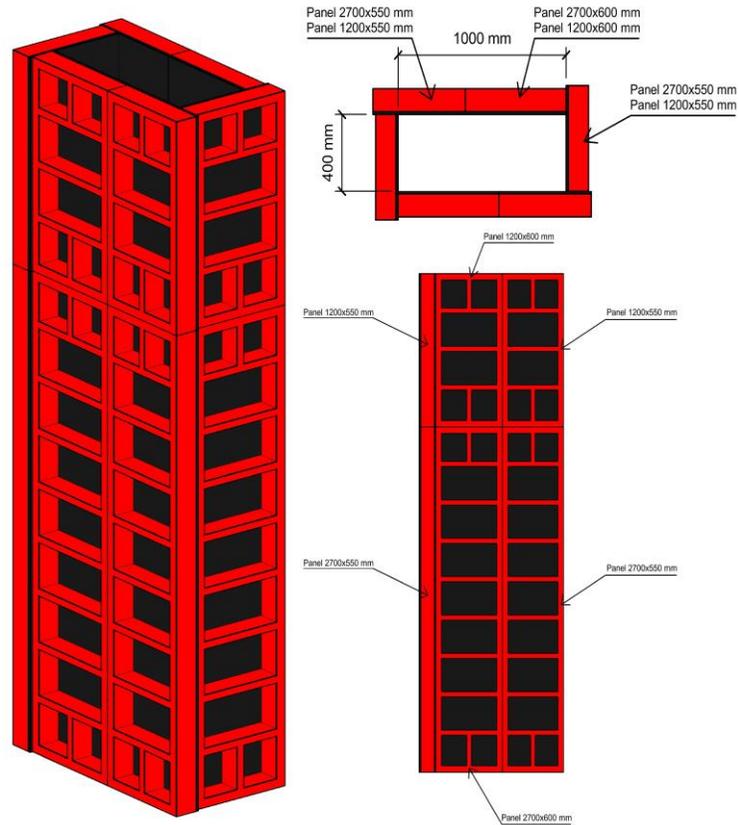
Vistas del conjunto de paneles para encofrar una columna de 400x1000 mm
